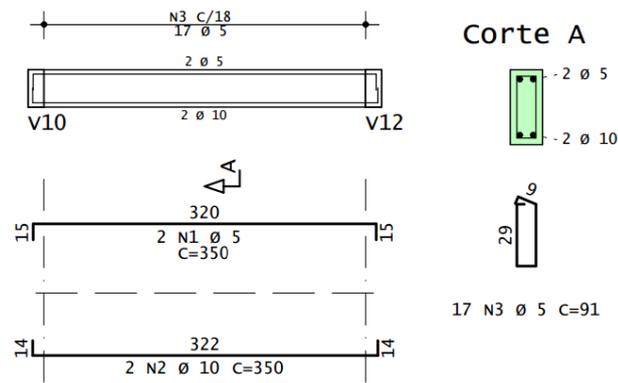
Armadura da viga baldrame V3 – pavimento térreo (nível 0,00)
